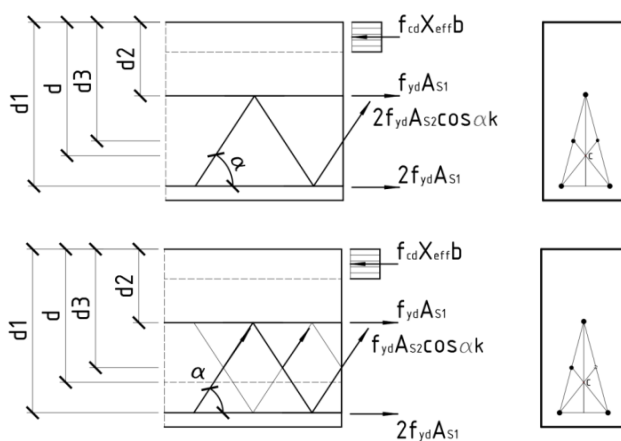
Схема усилий в сечении, нормальном к продольной оси изгибаемого железобетонного элемента с учетом количества наклонных стержней
